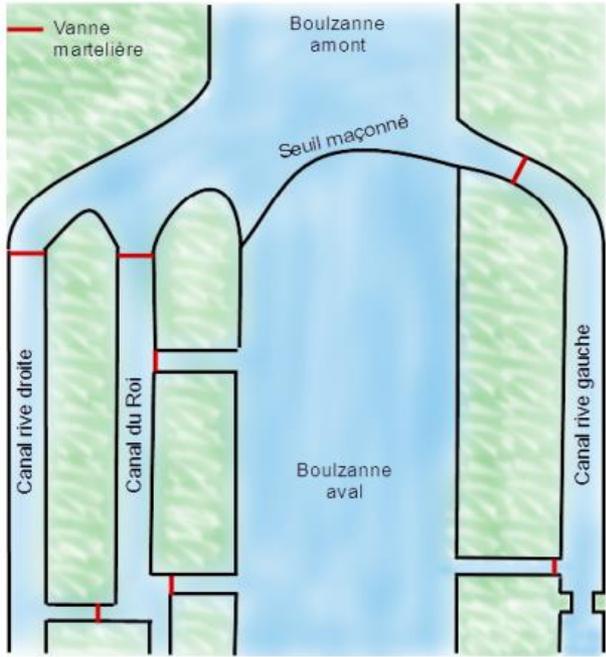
Plan de la prise d'eau Canal de Caudiès
